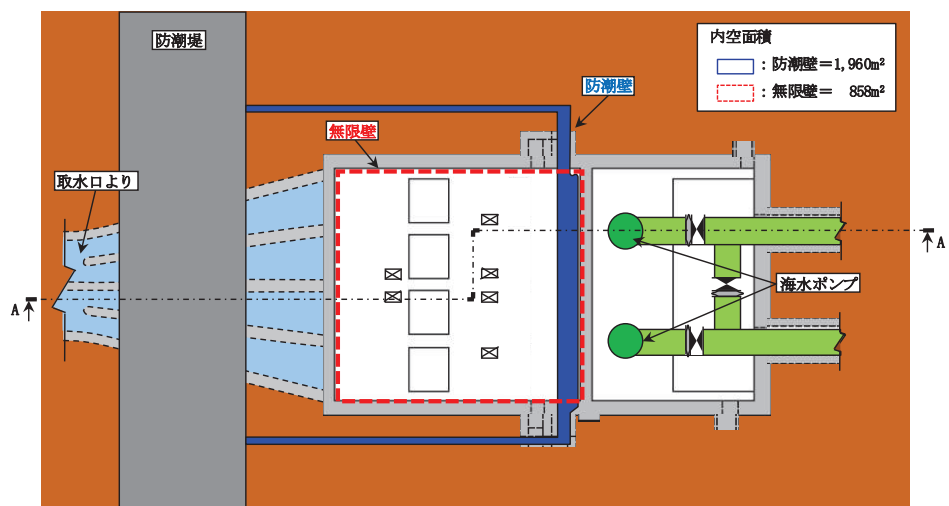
(1) 第3号機海水ポンプ室平面図
